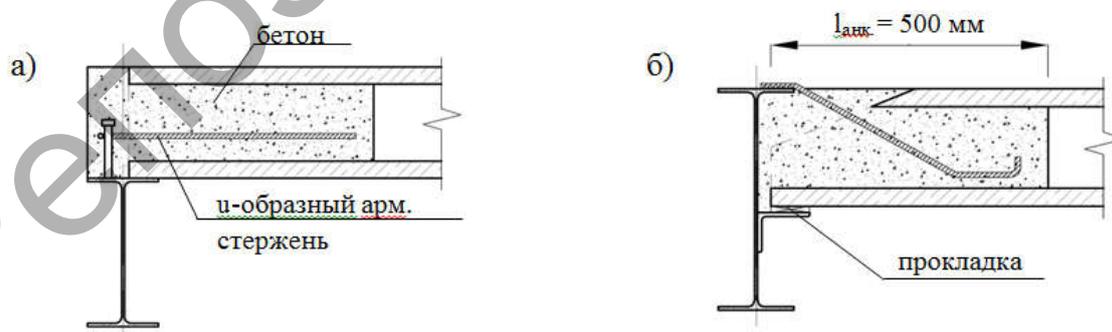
Закрепление сборной железобетонной плиты со стальным ригелем
